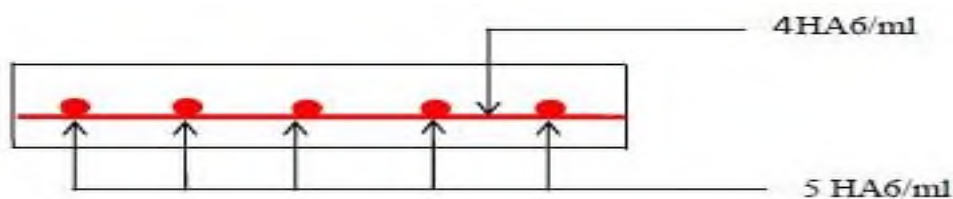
Figure II.4 Schéma de ferrailage de la dalle de compression
